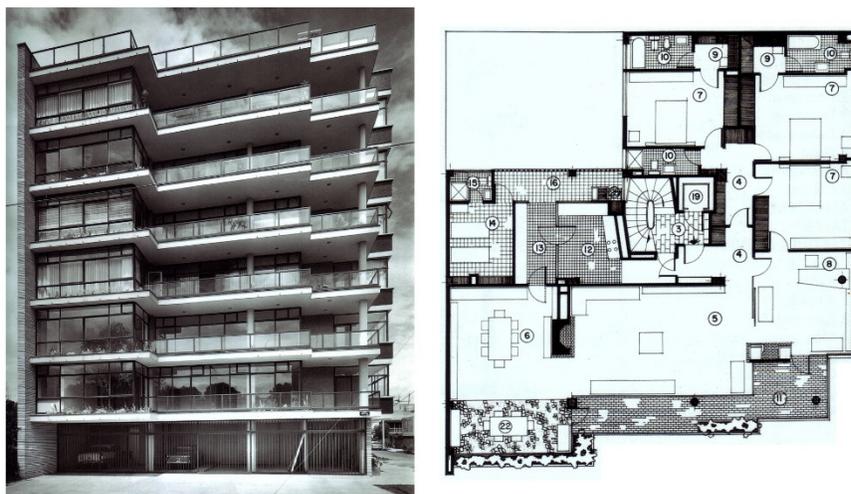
Vista exterior y planta tipo del edificio de apartamentos en Platón núm. 445 del arquitecto Vladimir Kaspé, ca. 1958
